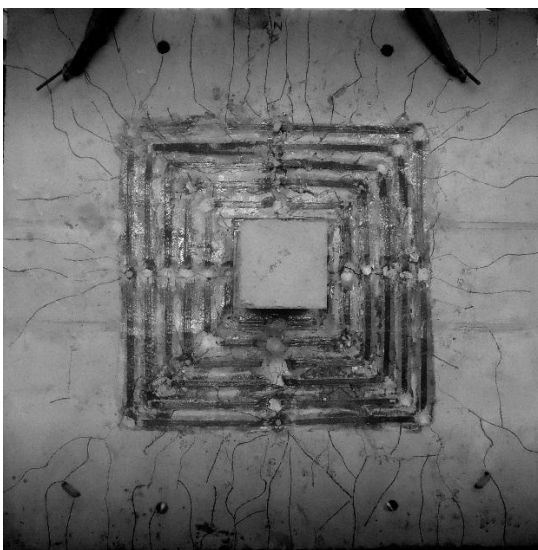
Padrão de Fissuração - LR-S
